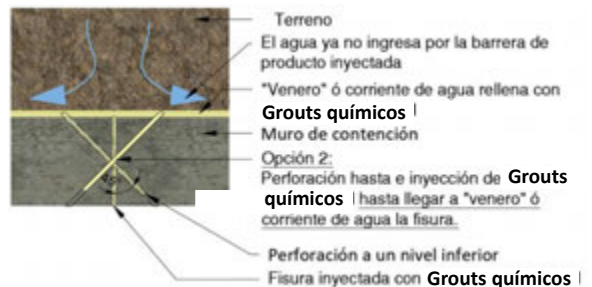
Vista en corte Superior – inyección con Grouts químicos restringiendo el paso del agua por la fisura y por la corriente agua entre el muro y el terreno
